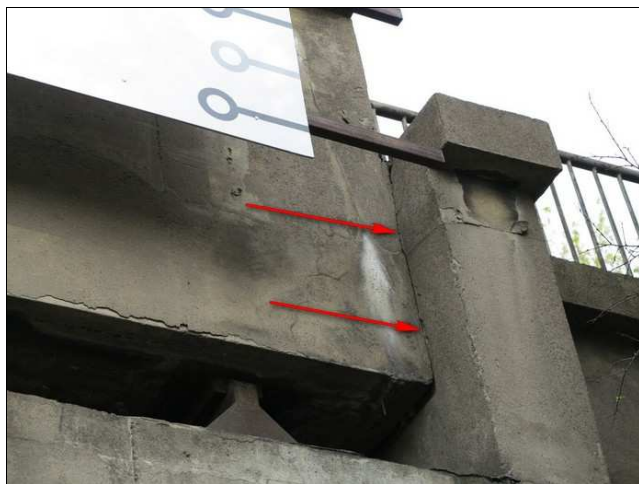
K 01, zapření konstrukce do závěrné zdi O 02
